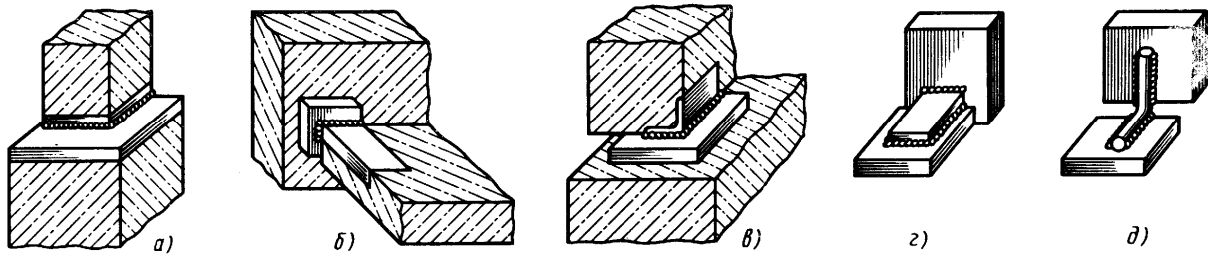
Монтажные сварные соединения сборных железобетонных элементов
